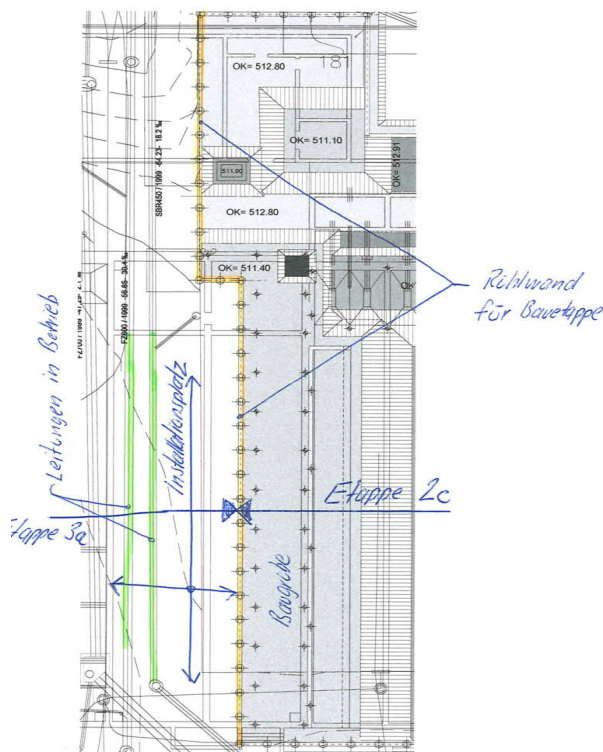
Planausschnitt Baugrube; Grundriss mit Rühlwand für Bauetappe 2b
